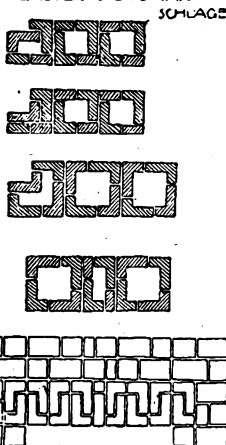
Bimsbetonhohlblock Bauart Lupescu
